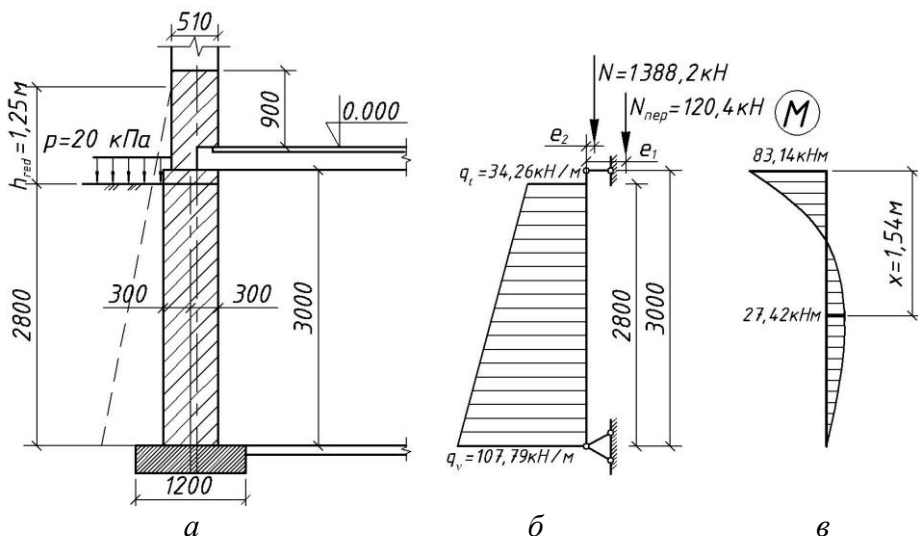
До прикладу 10.7: *a* – конструктивна схема стіни підвалу; *б* - розрахункова схема; *в* - епюра моментів
